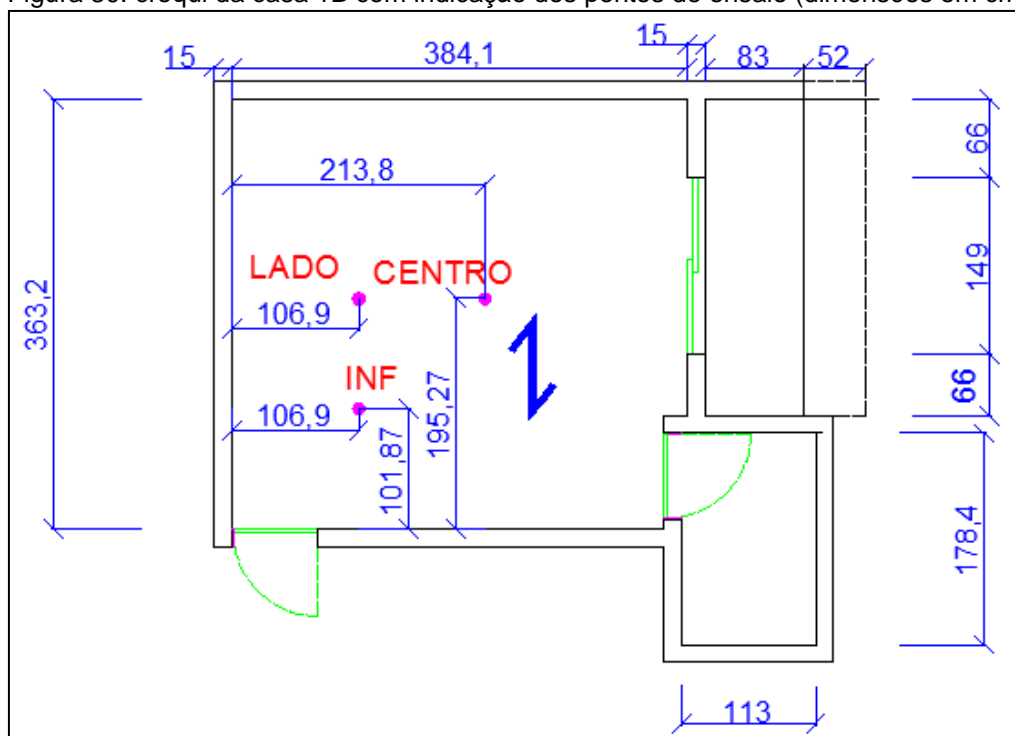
croqui da casa 1B com indicação dos pontos de ensaio (dimensões em cm)
